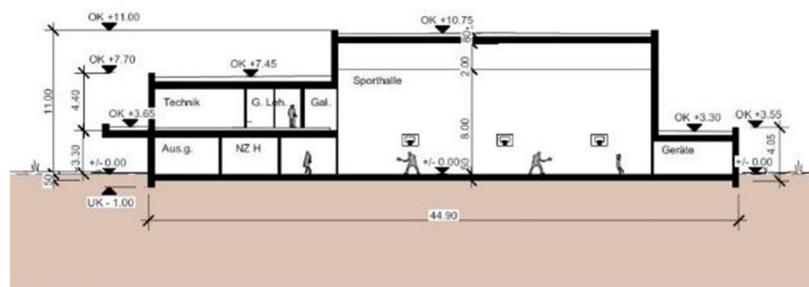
„aufgesetzte“ Doppelsporthalle B | Disposition 2 - Querschnitt
